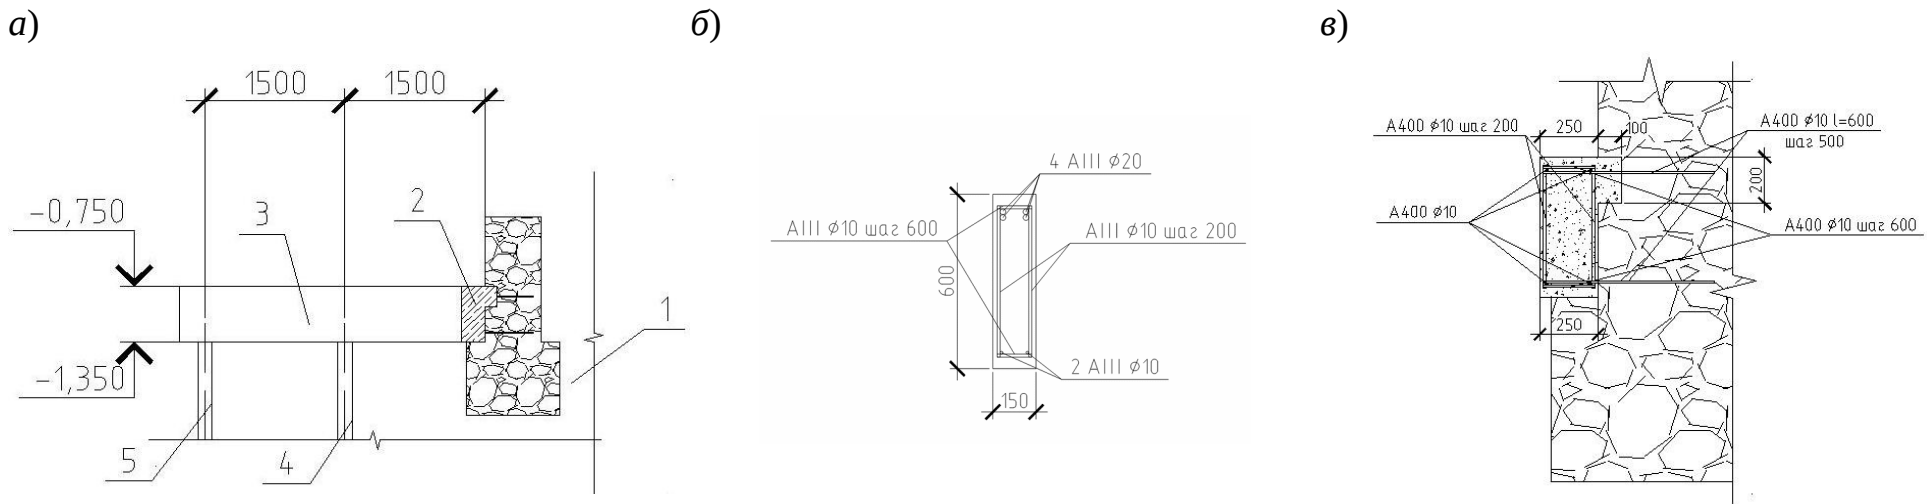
Конструкція залізобетонного ростверку у вигляді горизонтальної рами: а – схема конструкції: 1 – існуючий фундамент; 2 – подовжній ригель рами, суміщений з монолітним залізобетонним поясом; 3 – поперечний
